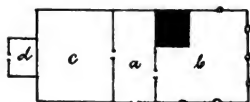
Grundriss eines russisch-karelischen Hauses. Karelien. Archangel.
